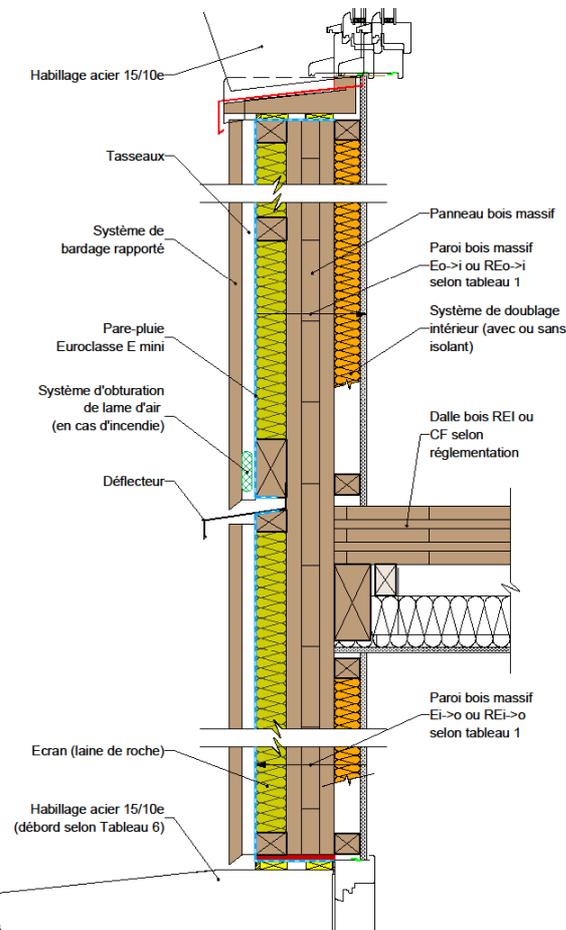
Façade/mur en panneaux bois massif & plancher en panneaux bois massif.
